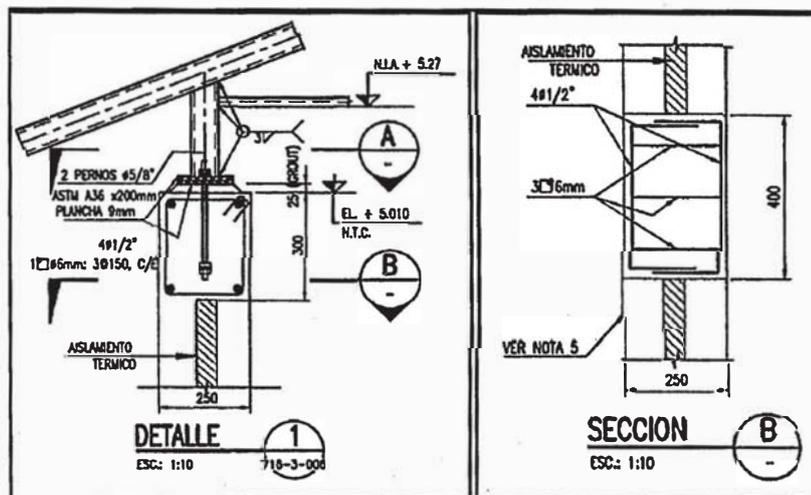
Detalle de refuerzo para canastillas de acero corrugado.
